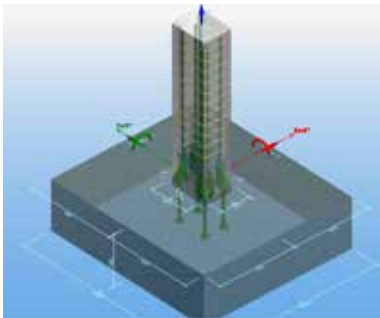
Розрахункова модель вузла приєднання фундаменту на анкерних болтах
